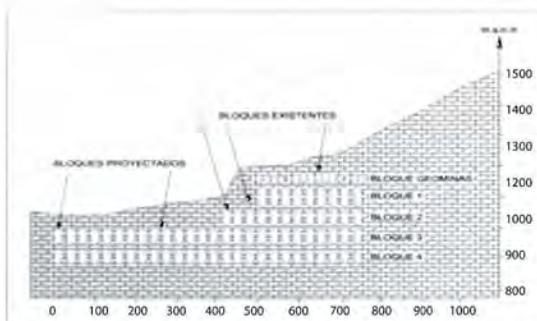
Sección transversal vertical esquemática de las excavaciones en la mina El Toro.
